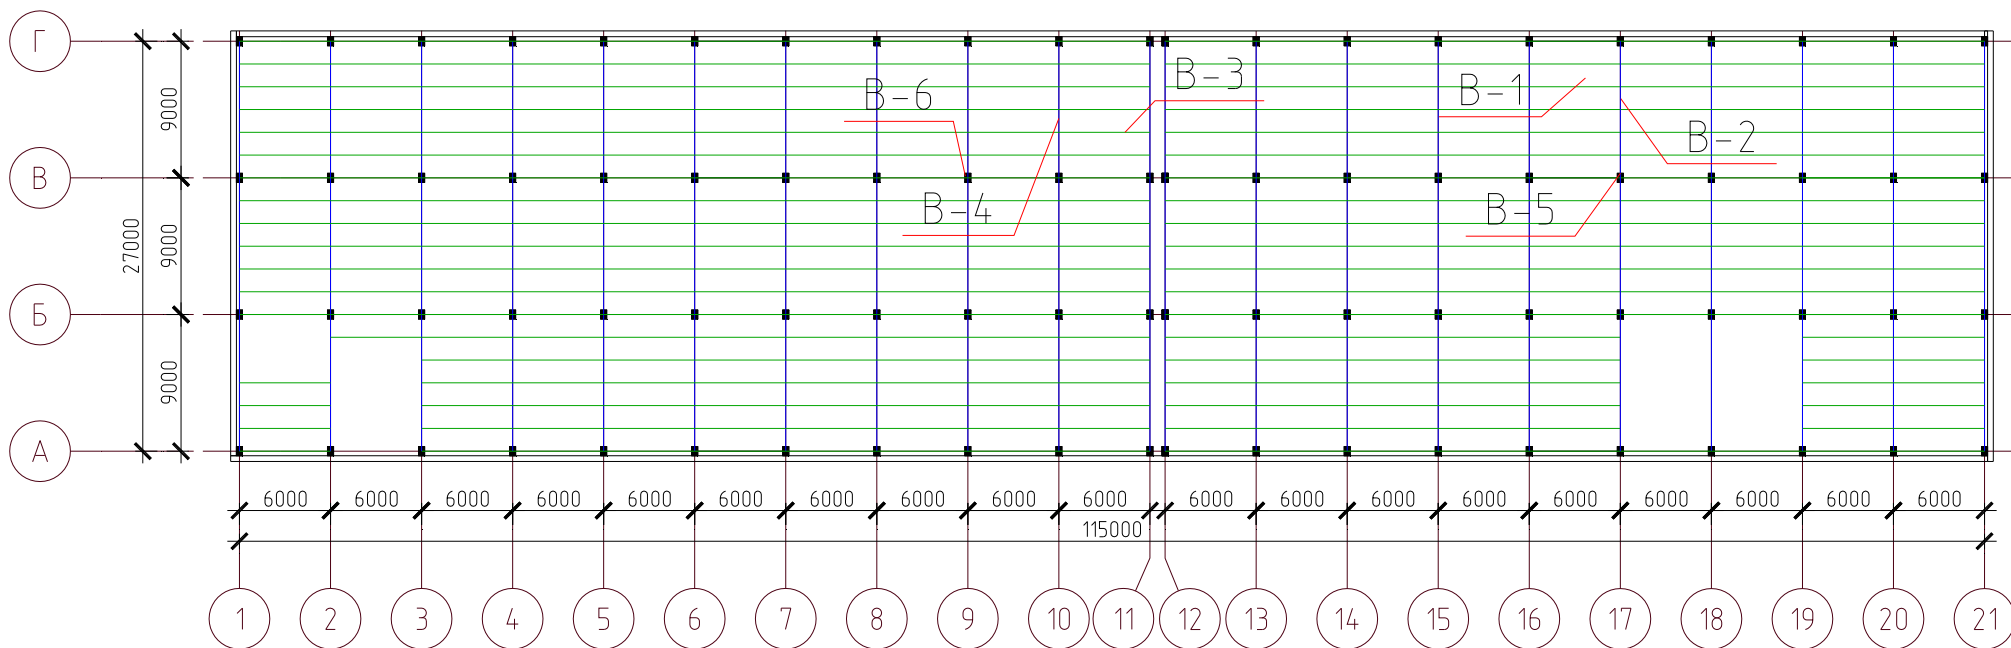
Места вскрытий ригелей и плит перекрытия.
